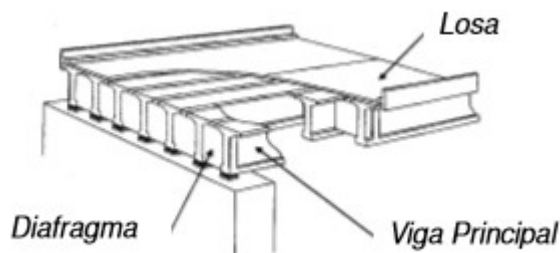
Viga tipo T. Fuente: : Manual de Puentes MOPT, 2007
